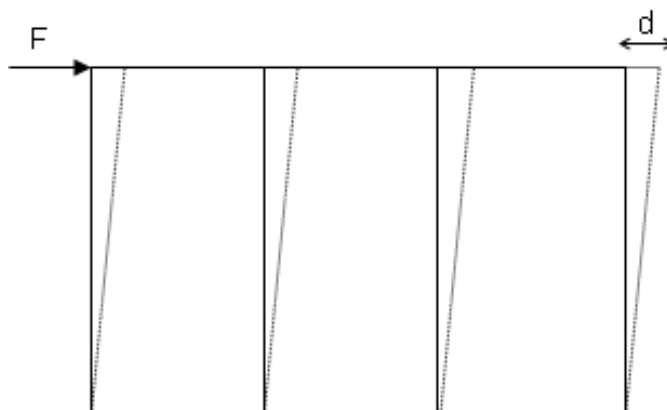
DISPOSITIF DE L'ESSAI DE POUSSEE HORIZONTALE PONCTUELLE SUR LE POTEAU.
